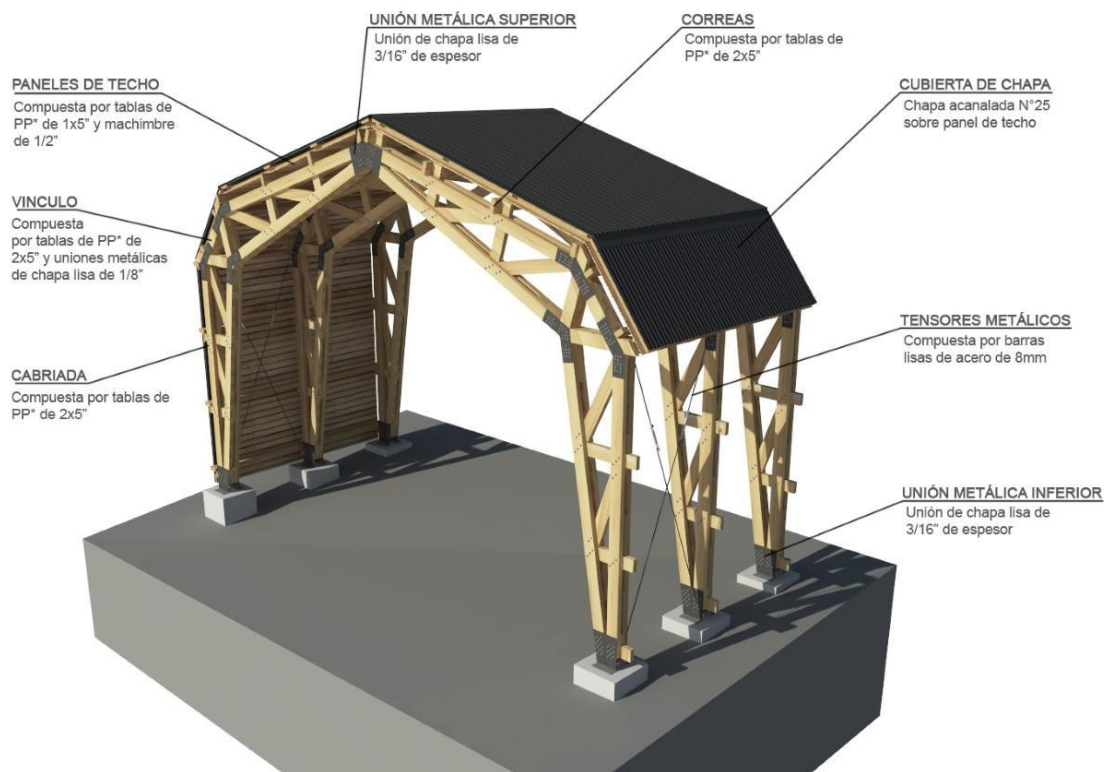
El sistema constructivo. Fuente: Equipo Co-construcción de Conocimientos, 2013.
